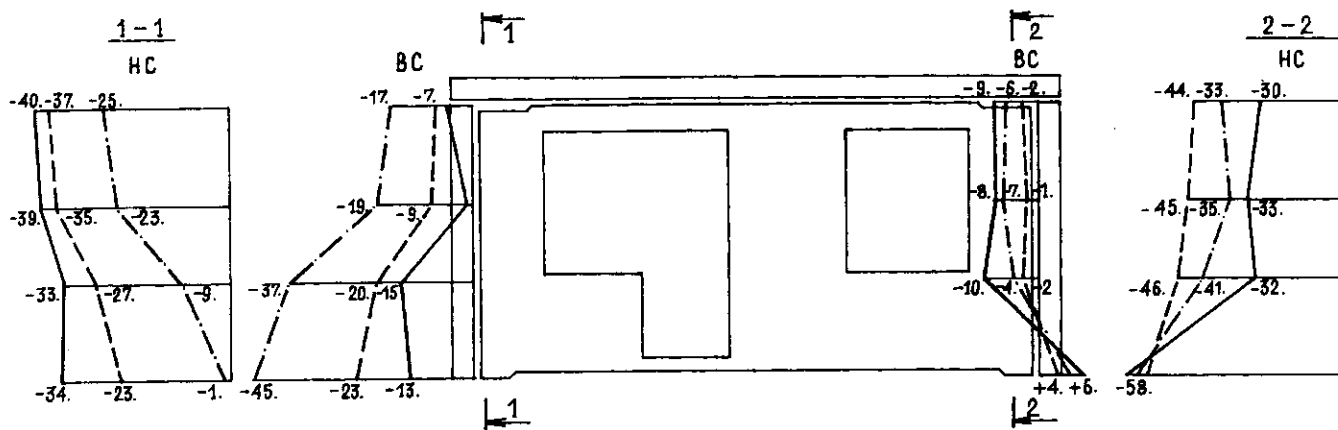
Распределение усилий (%) по сечениям поэтажно несущей конструкции
